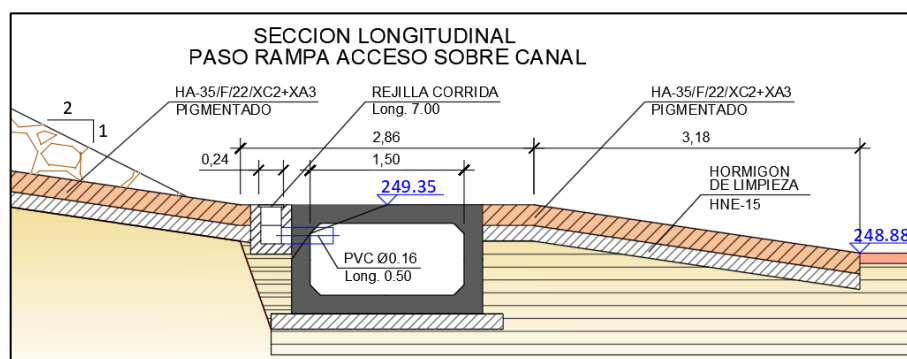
Sección transversal de la sección de marcos de hormigón pigmentado.
